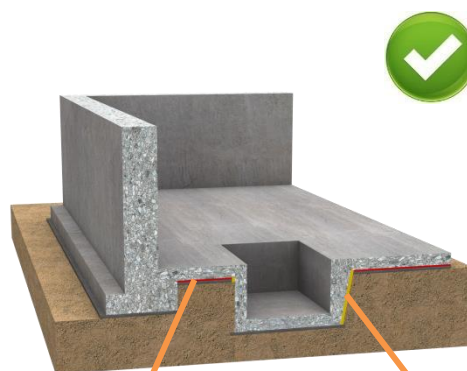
Zalecane rozwiązanie projektowe dla systemu „białej wanny”
